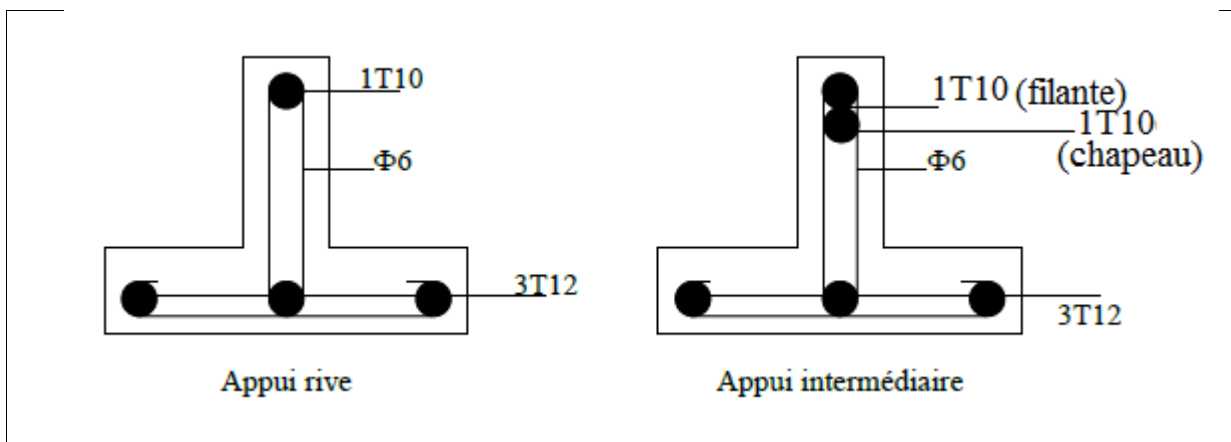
Dessin de ferrailage des poutrelles des étages courants
